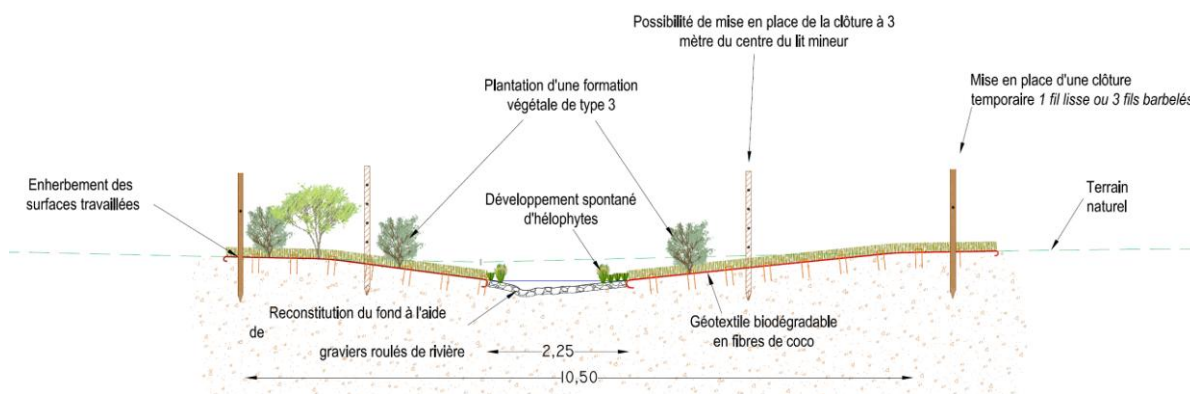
Coupe transversale du ruisseau de Joux renaturé
